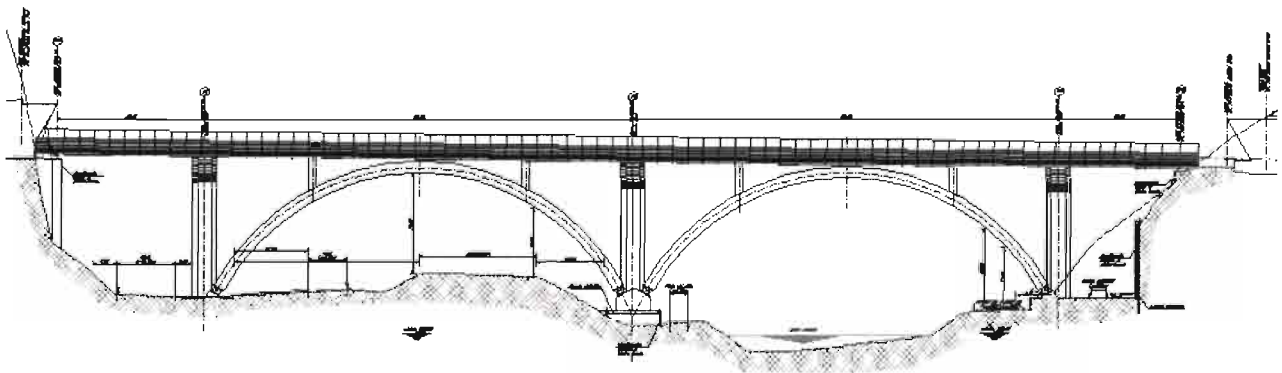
Ponte Fiume Isarco: Prospetto Viadotto Binario Pari
